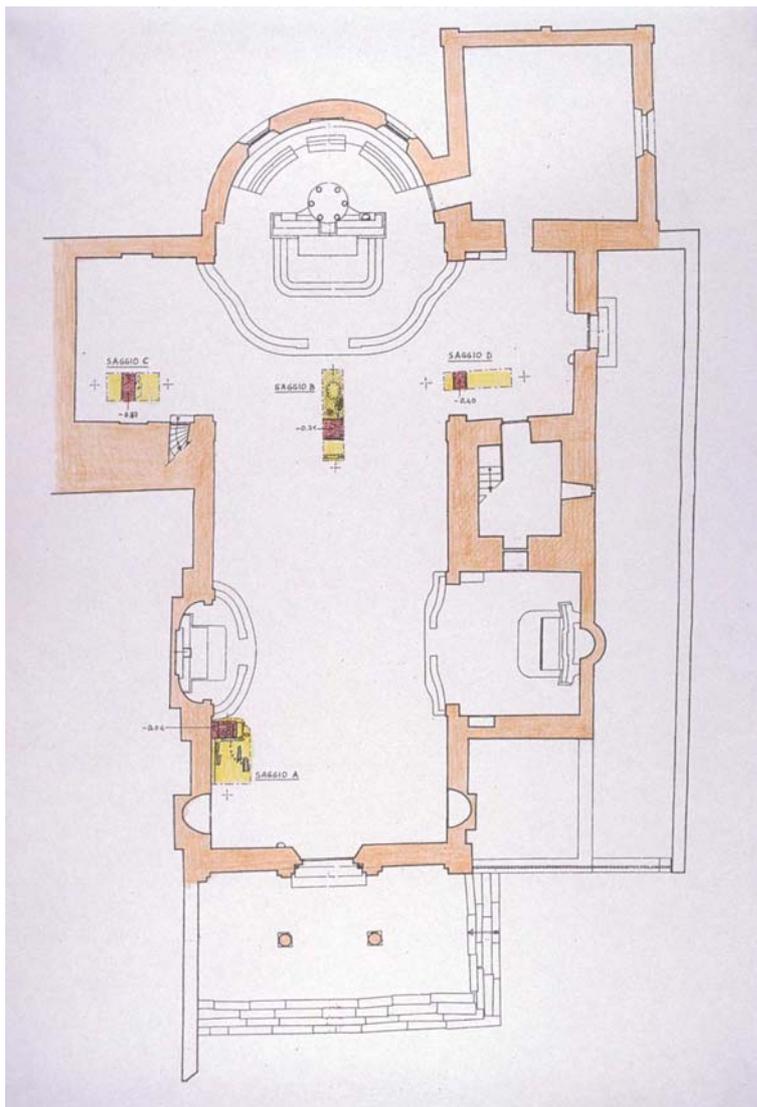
Planimetria della chiesa con evidenziate la pianta della fase romanica e l'ubicazione dei saggi di scavo.
